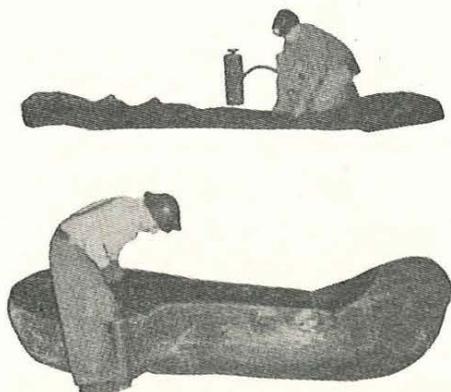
Tubes à gonfler pour la construction de serrements.
